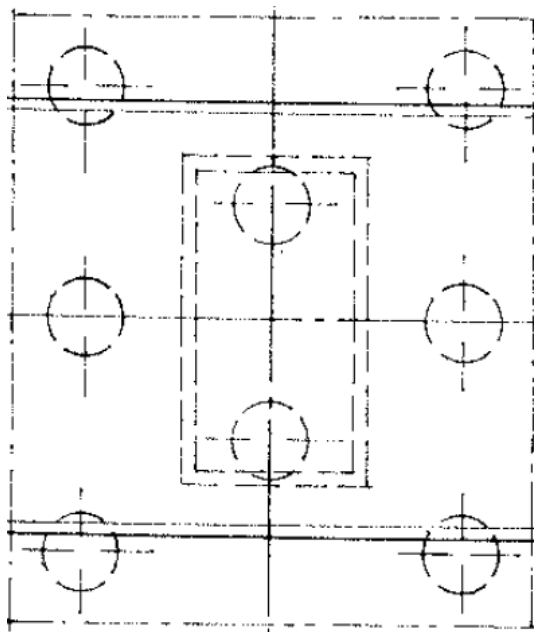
Pianta Pile a 8 pali (P4÷P15 e P25)
